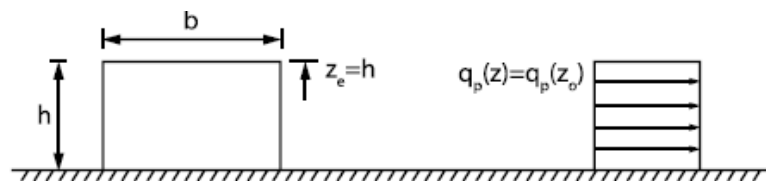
К расчету вертикальных стен прямоугольных в плане зданий при $h \leq b$
